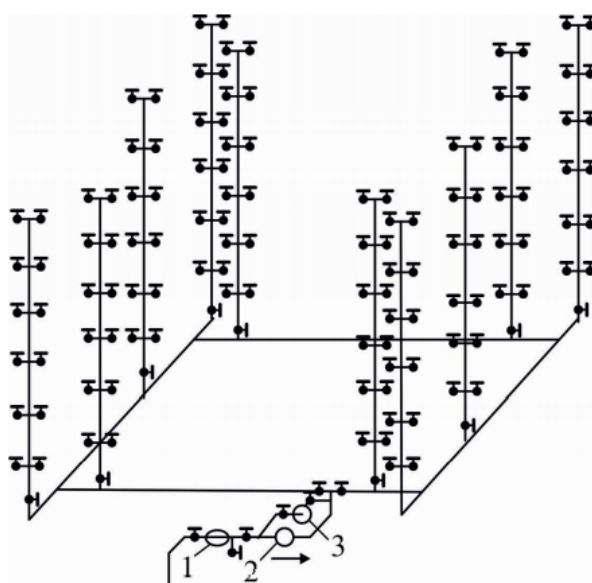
Схема водопровідного введення в будинок з насосом:
